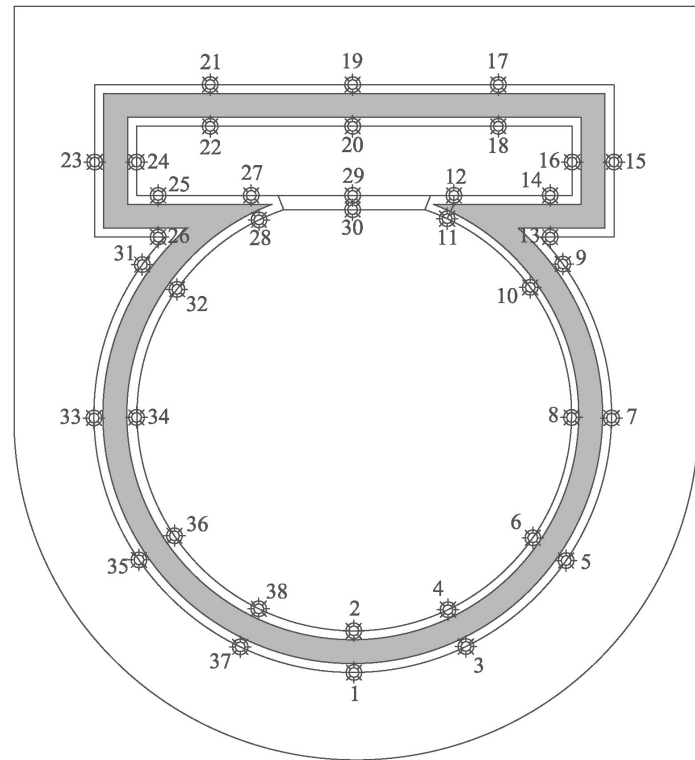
61 – Installazione di 38 martinetti idraulici di piccole dimensioni
